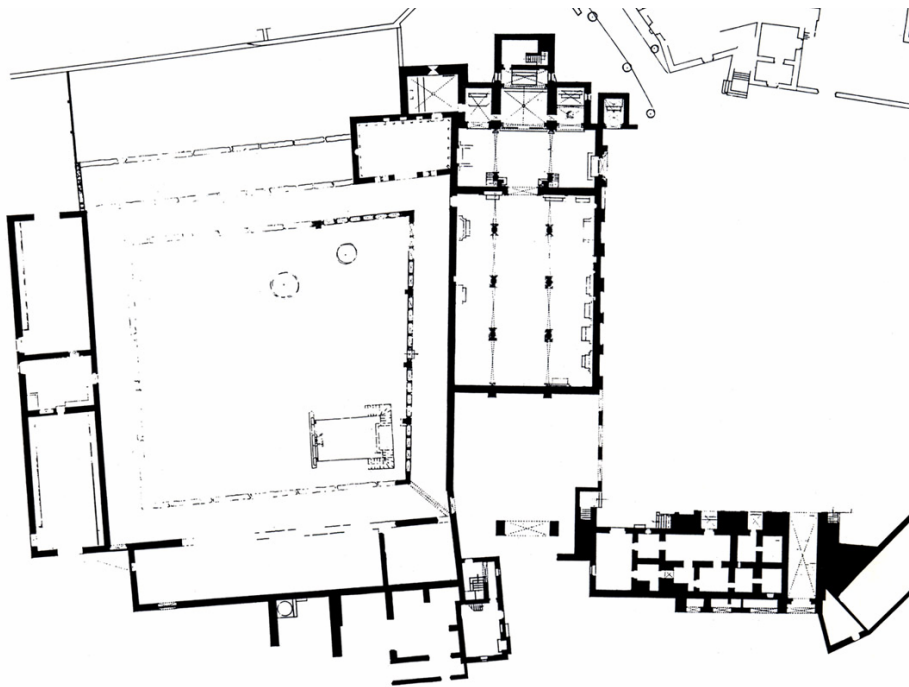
Santa Maria de Almoster, planta do conjunto monástico (DGEMN).
